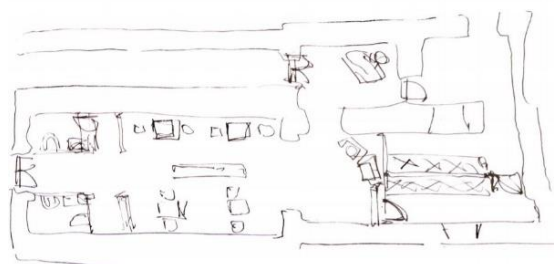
Planta da possível entrada pelo corredor; *Fonte: Mariana Vieira.
